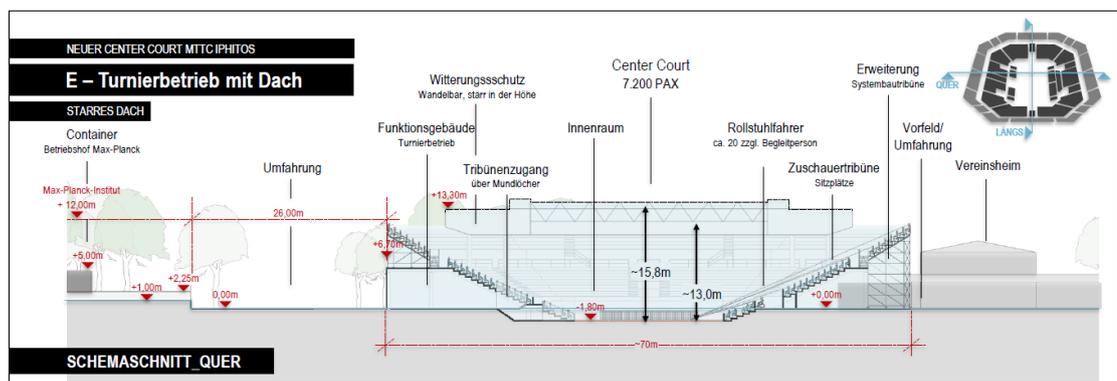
Schemaschnitt quer – Turnierbetrieb
